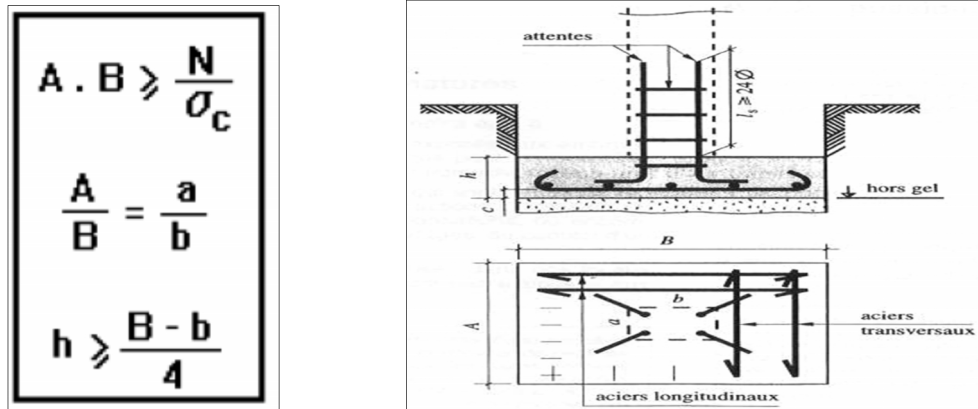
Dimensions et la disposition des armatures pour une semelle isolée.
